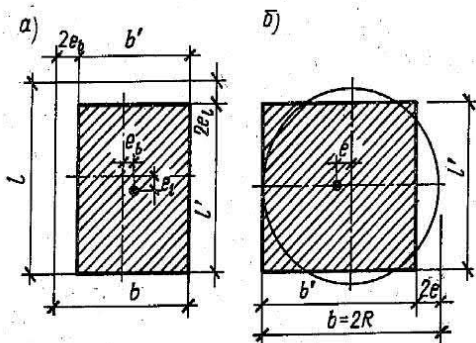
Схема к определению приведенных размеров прямоугольного (а) и круглого (б) фундаментов
